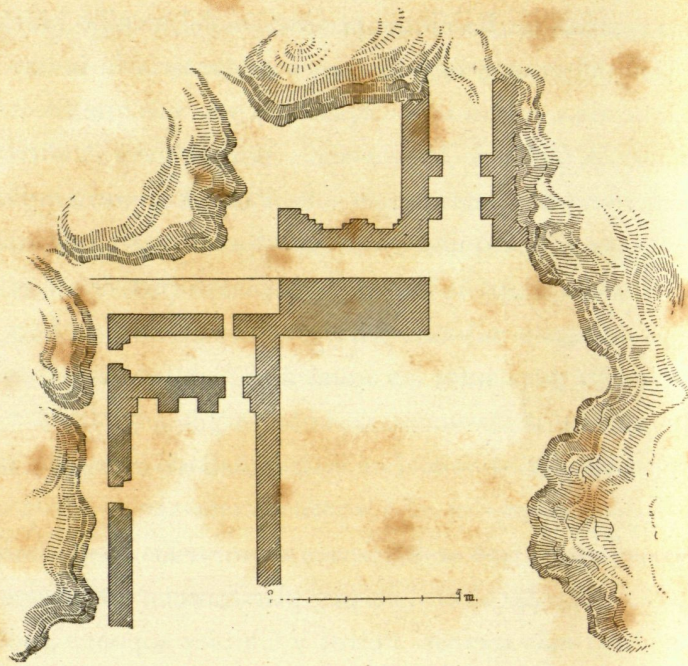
CÁMARAS DE UN PALACIO DESCUBIERTO EN ABU-SHAREIN: PLANTA (SEGÚN TAYLOR)
